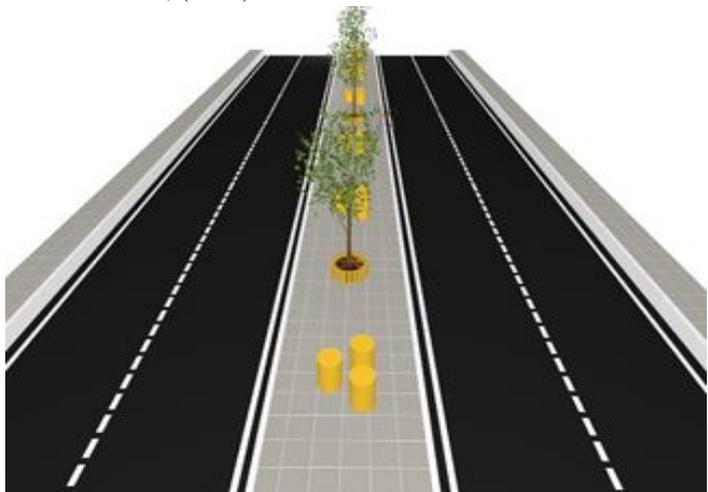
Canteiro central da Avenida Getúlio Vargas com as placas pré-moldadas de concreto com PET, vista longitudinal.
